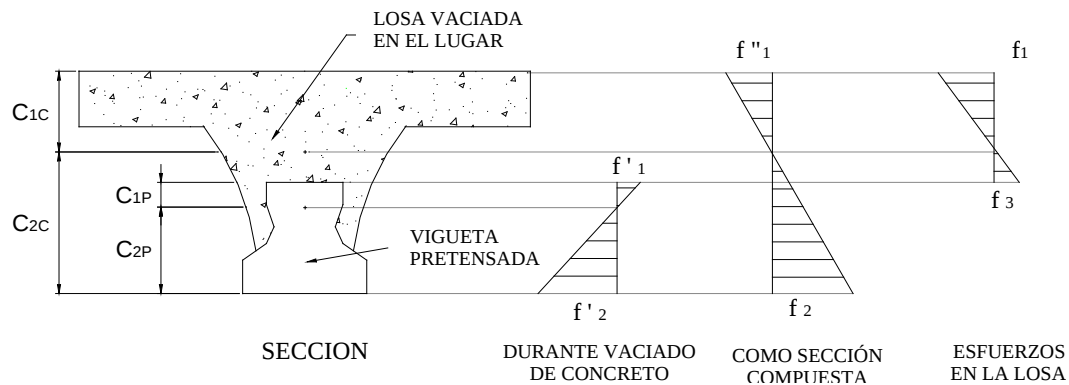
Esfuerzos actuantes en la sección de la viga.
